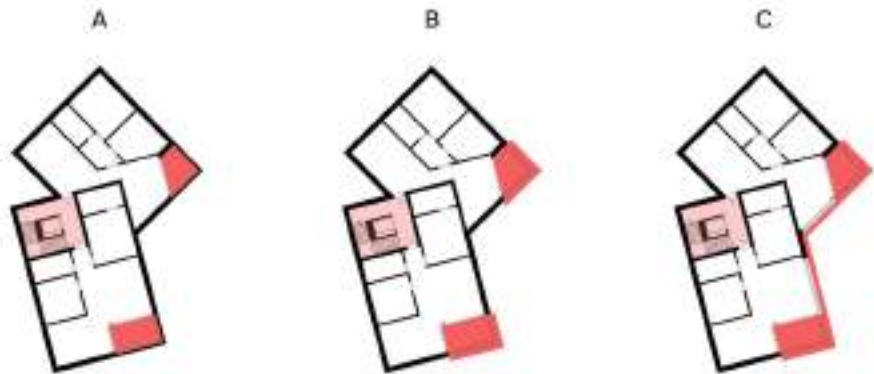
Fassadenkonzeptionen: Umgang mit Balkonsituationen
